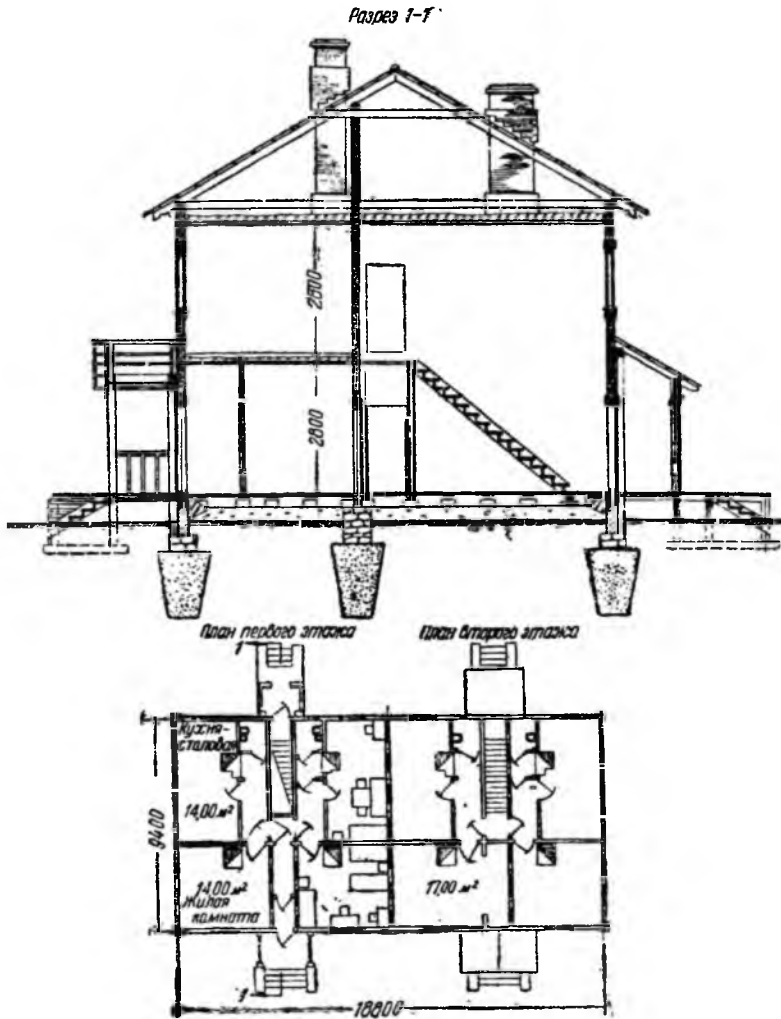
План и разрез восьмиквартирного двухэтажного жилого дома с печным отоплением
